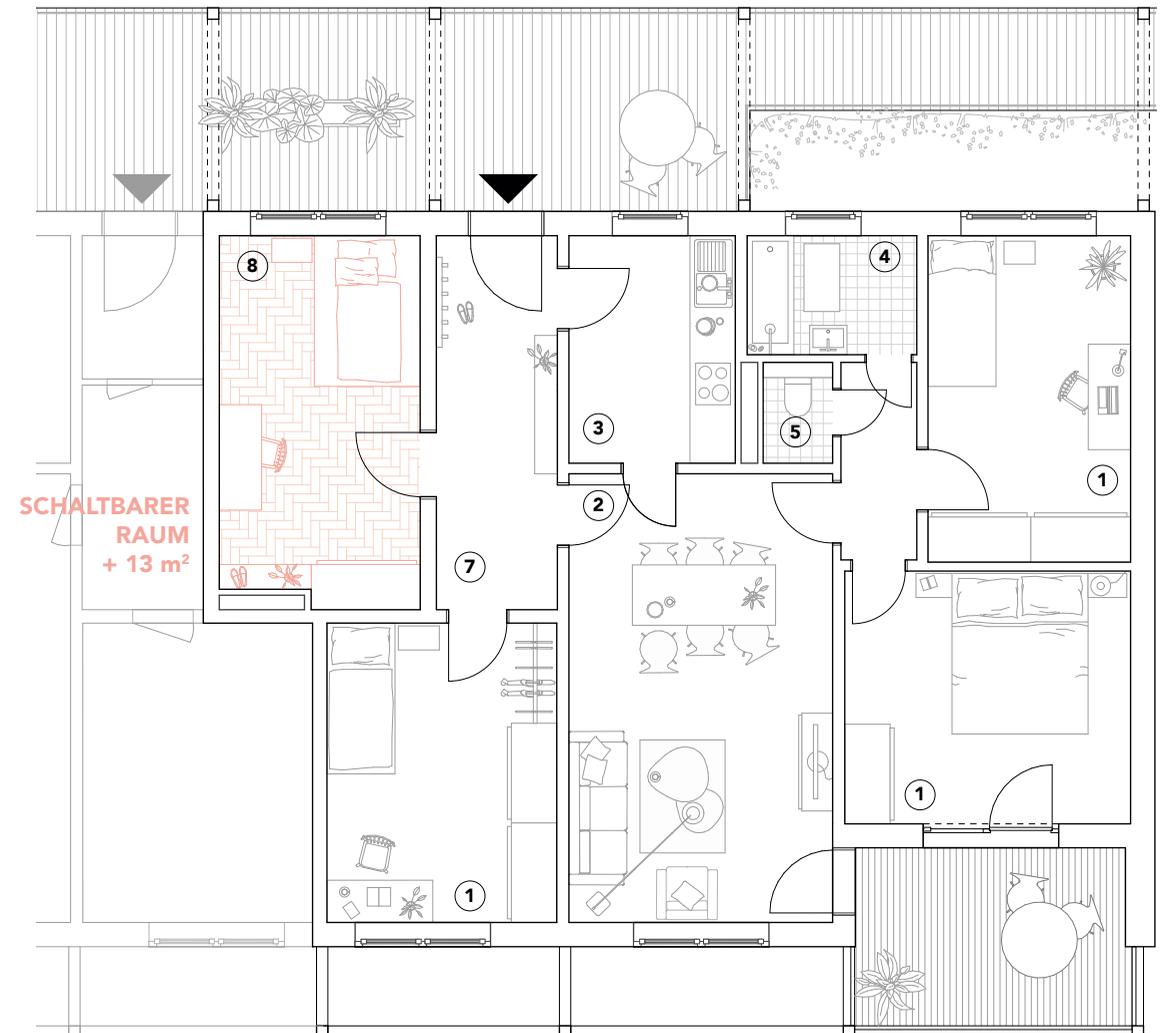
Grundriss Wohnung A M 1:100
